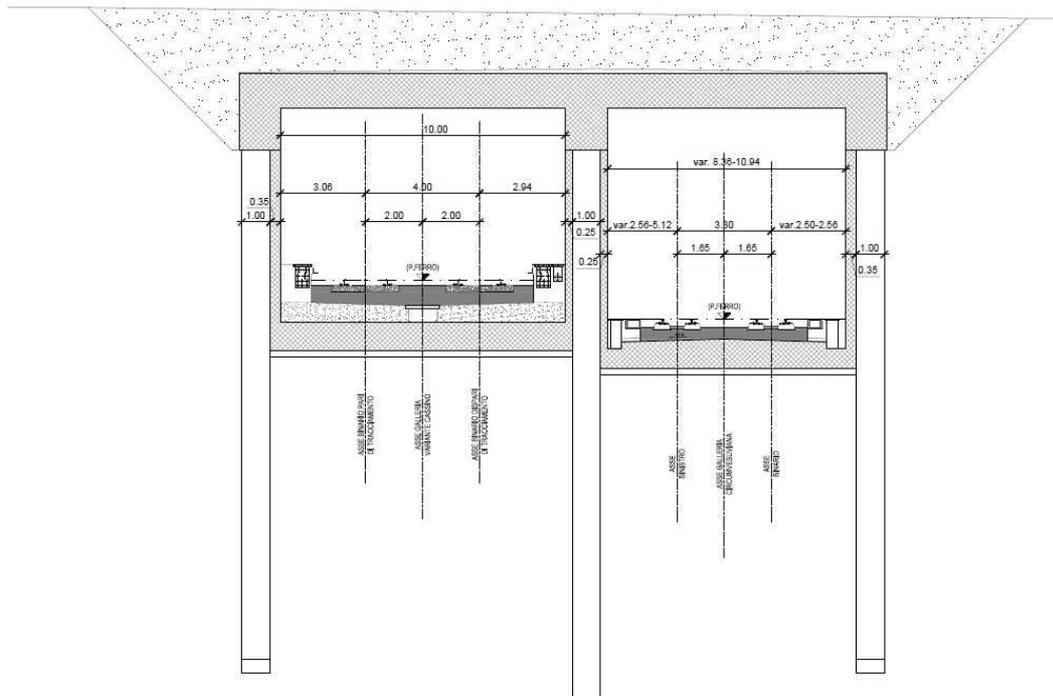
sezione trasversale a doppia canna in galleria: tipo C1 (da elaborato 1.f)
